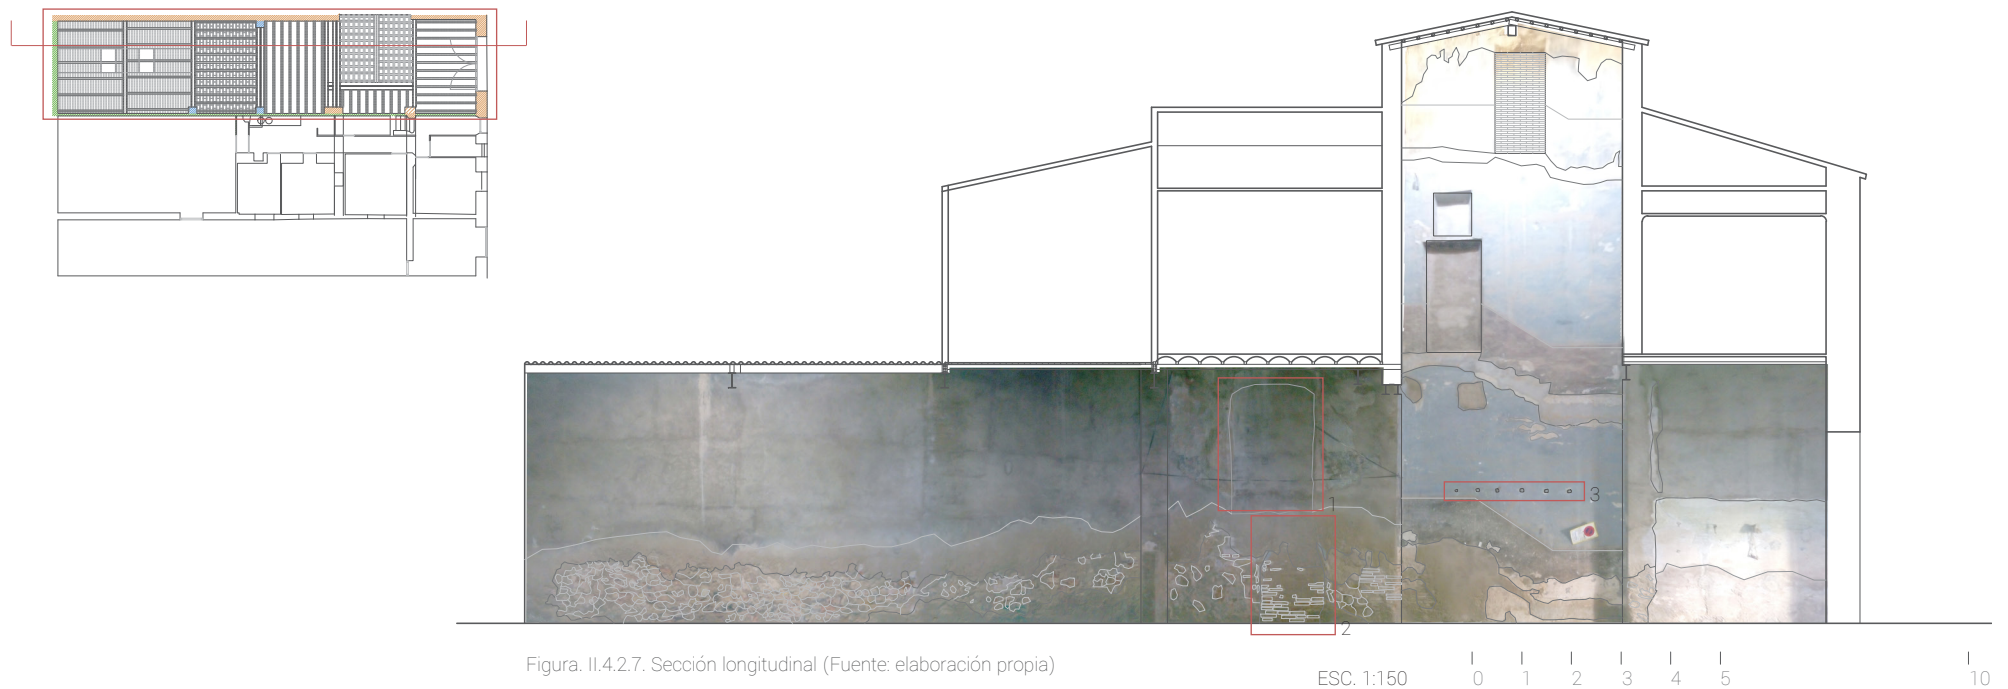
Sección longitudinal (Fuente: elaboración propia)
